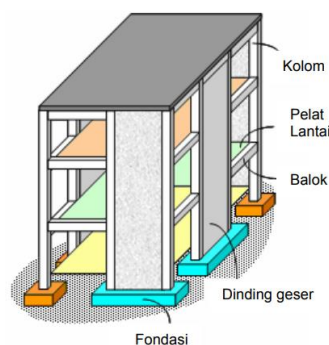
Struktur Dinding (*Wall System*) Beton Bertulang
